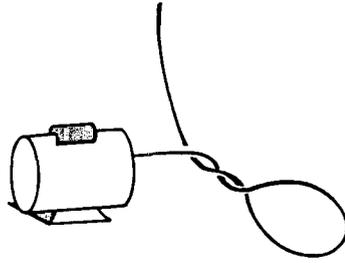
Eixo flexível enrolado sobre si mesmo.
